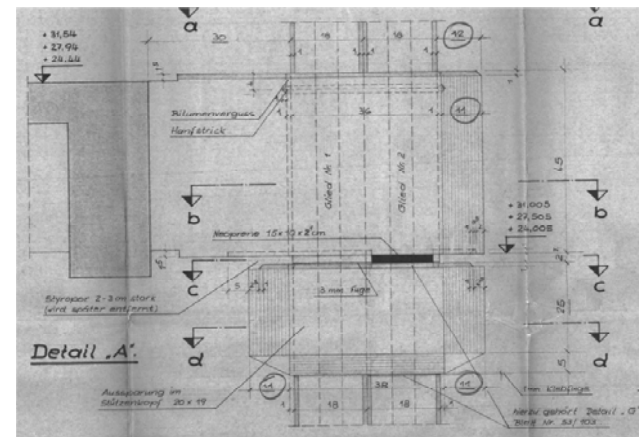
Schematische Skizze Balkenkopfende mit Spanngliedführung (hier exemplarisch Detail der Geschosse 4-6 mit 2 Spanngliedern)
